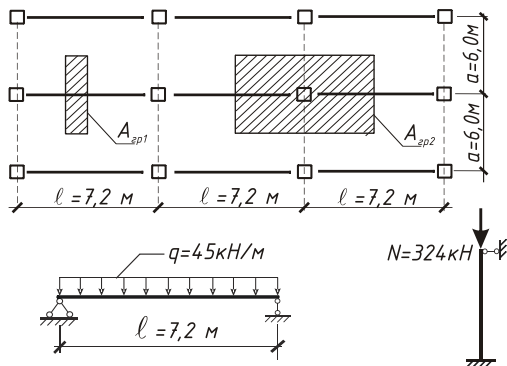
Грузовая площадь и расчетная схема балки и колонны
